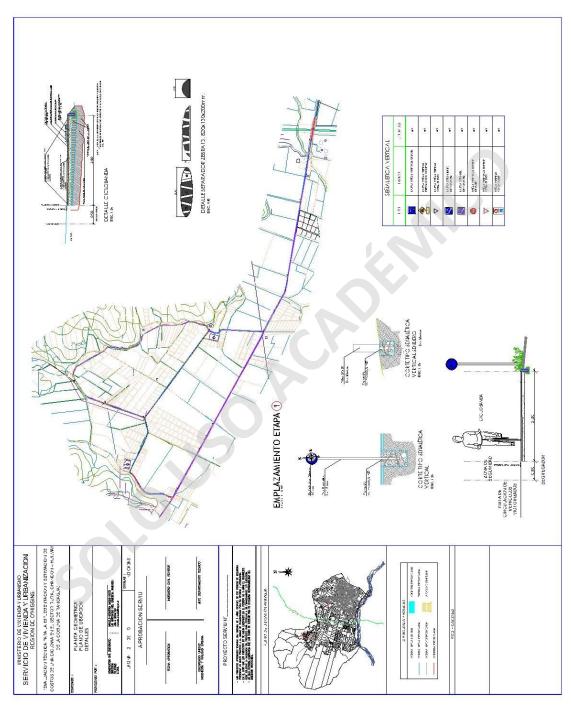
planimetría para proyecto SERVIU. (Detalles y señalética)
